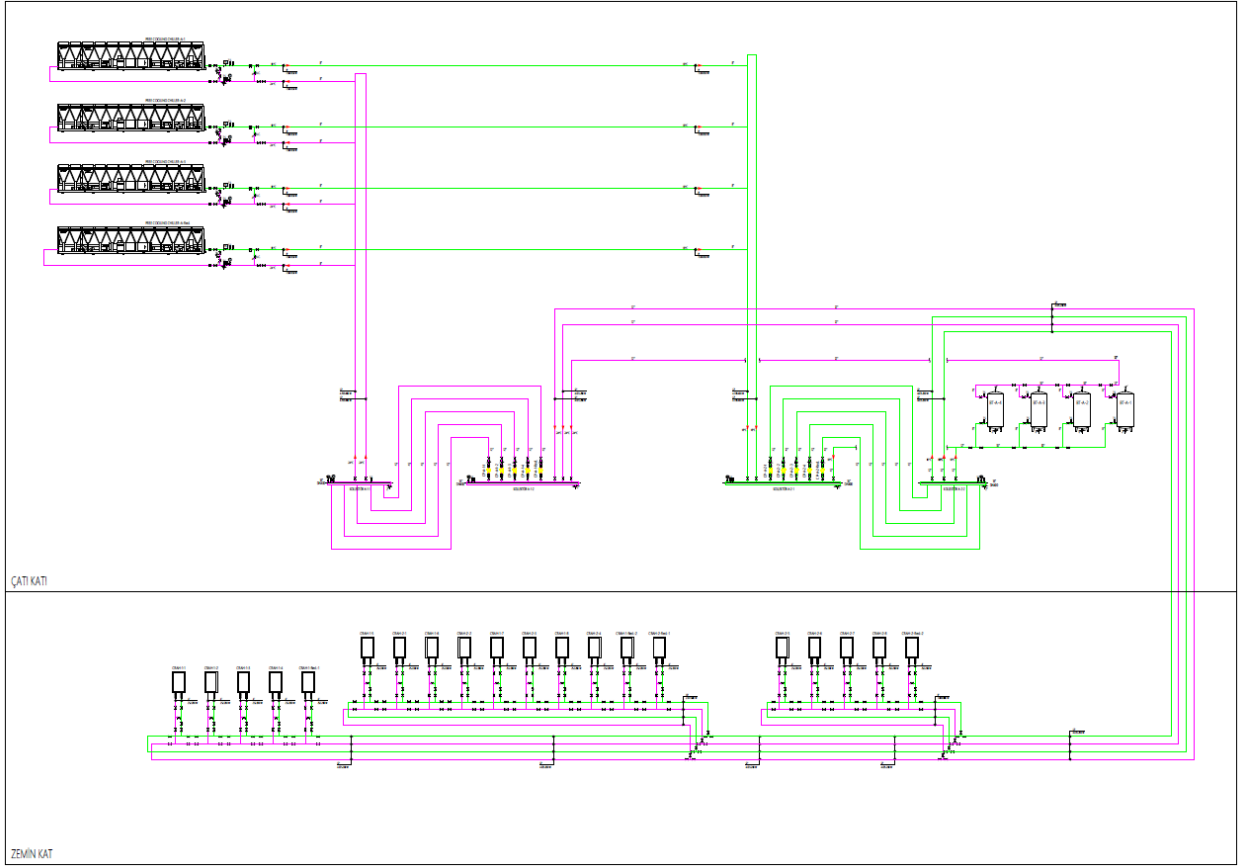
Hava Soğutmalı Veri Merkezinin Kat Planı Detay-5
